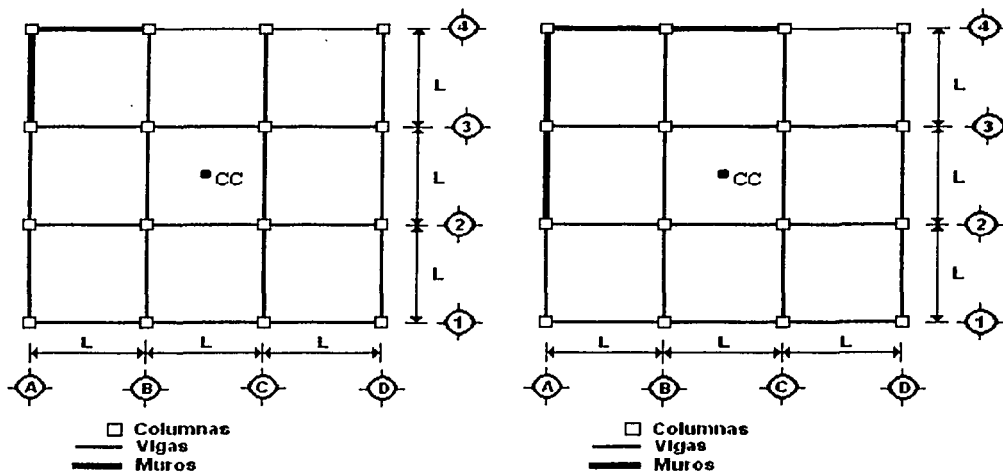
Planta tipo de modelos de 3-9 niveles. Fig.5.2 Planta tipo de modelos de 12 y 15 niveles.
